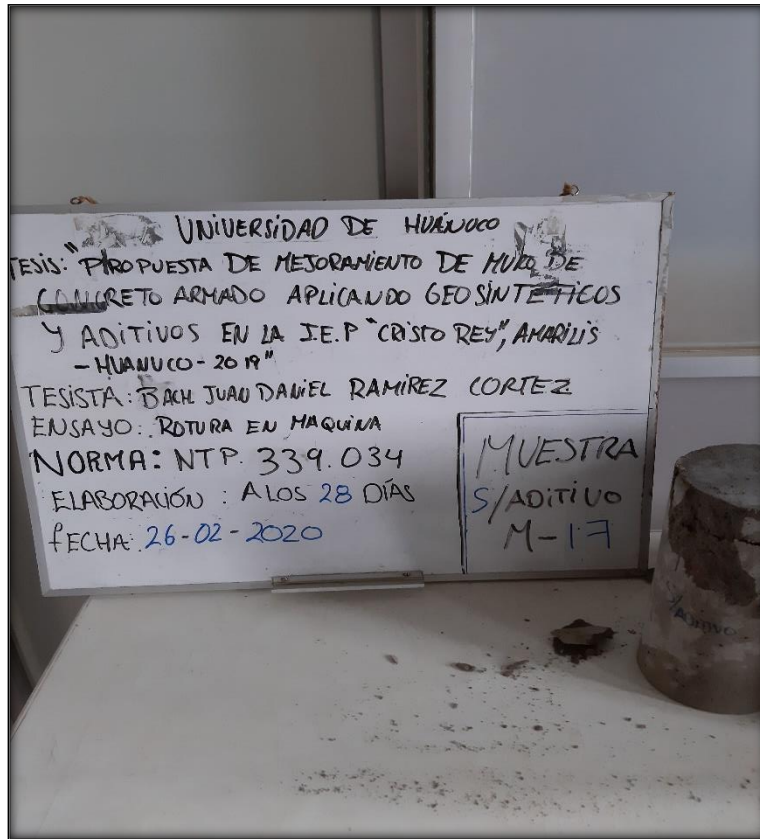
Rotura de probeta con aplicación de aditivo a los 28 días de curado
